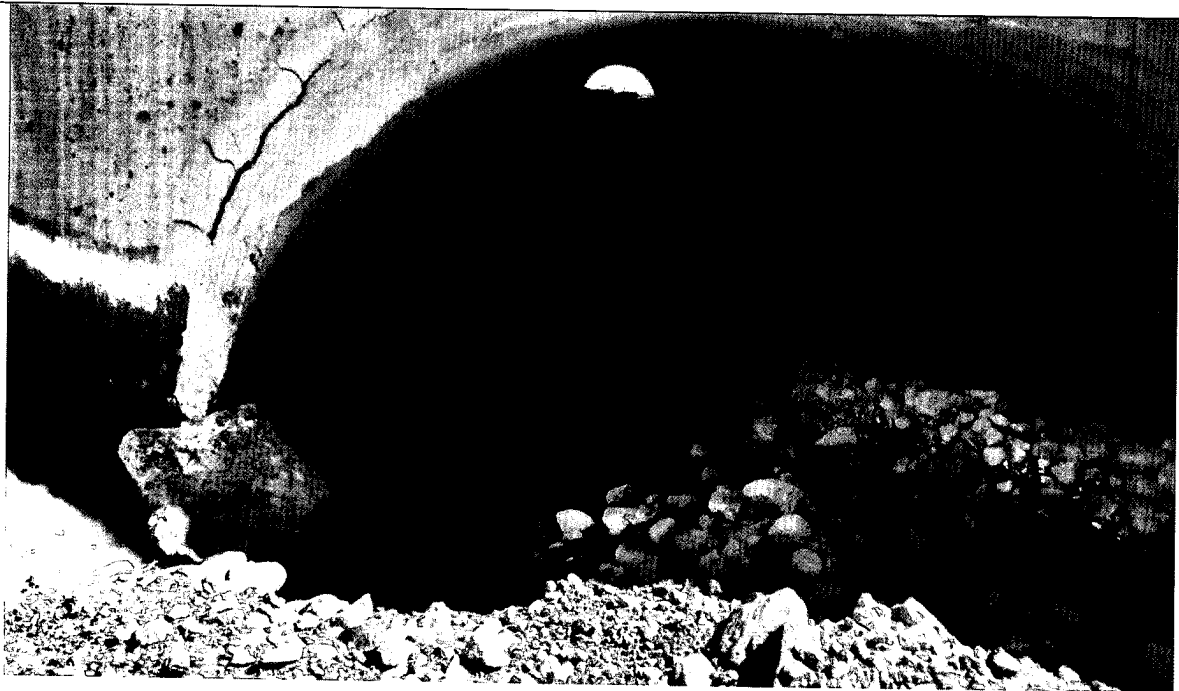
Alcantarilla N°2 en camino de acceso al puente El Yeso.
